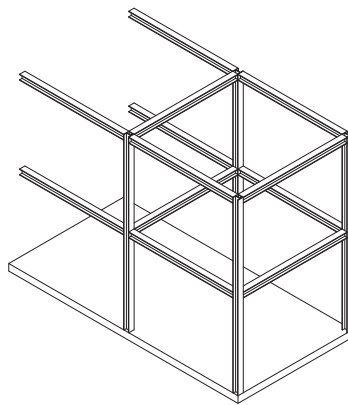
Axonometría constructiva sistema viga-pilar de acero.
